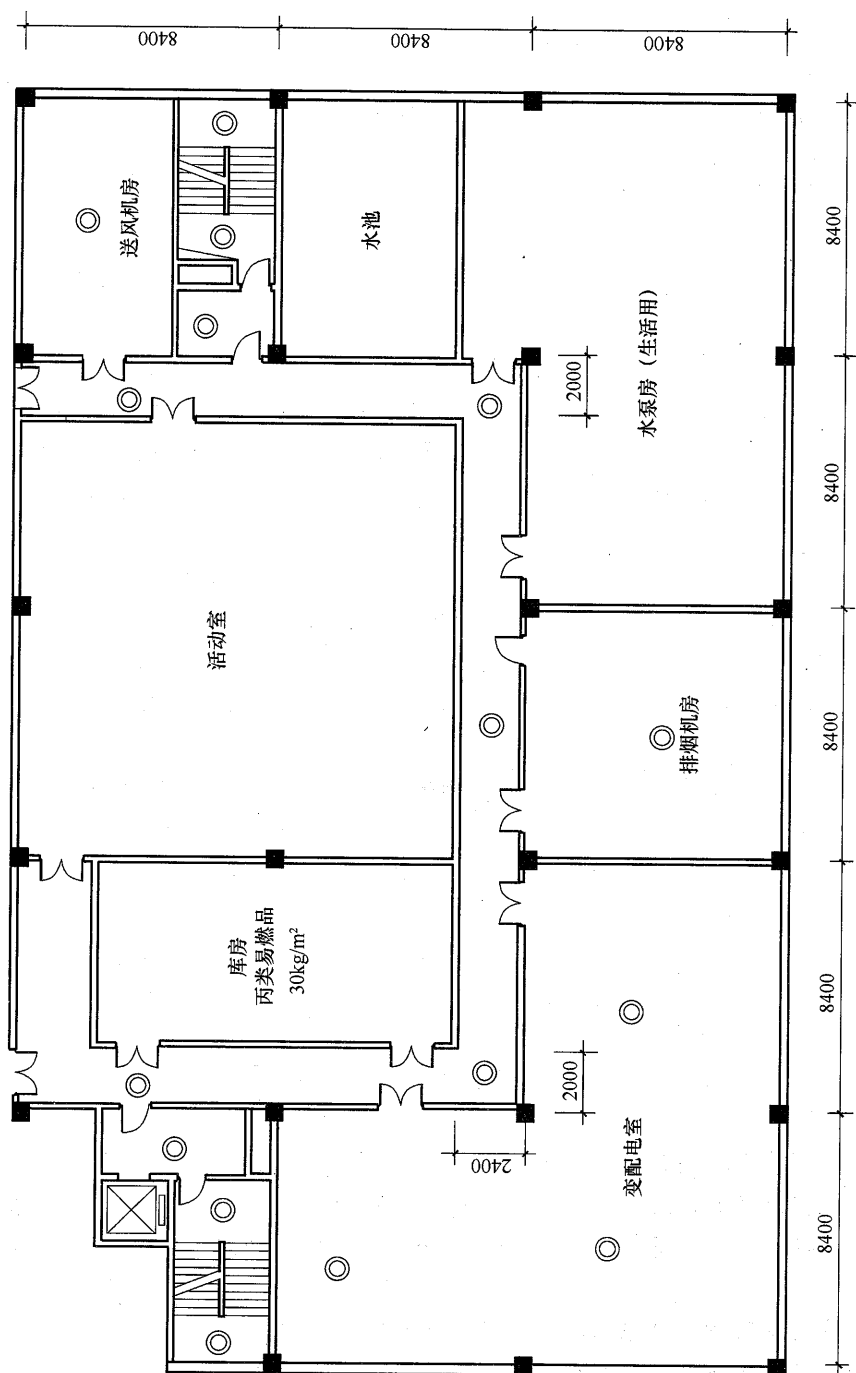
地下室平面图应急照明灯布置(参考答案)
